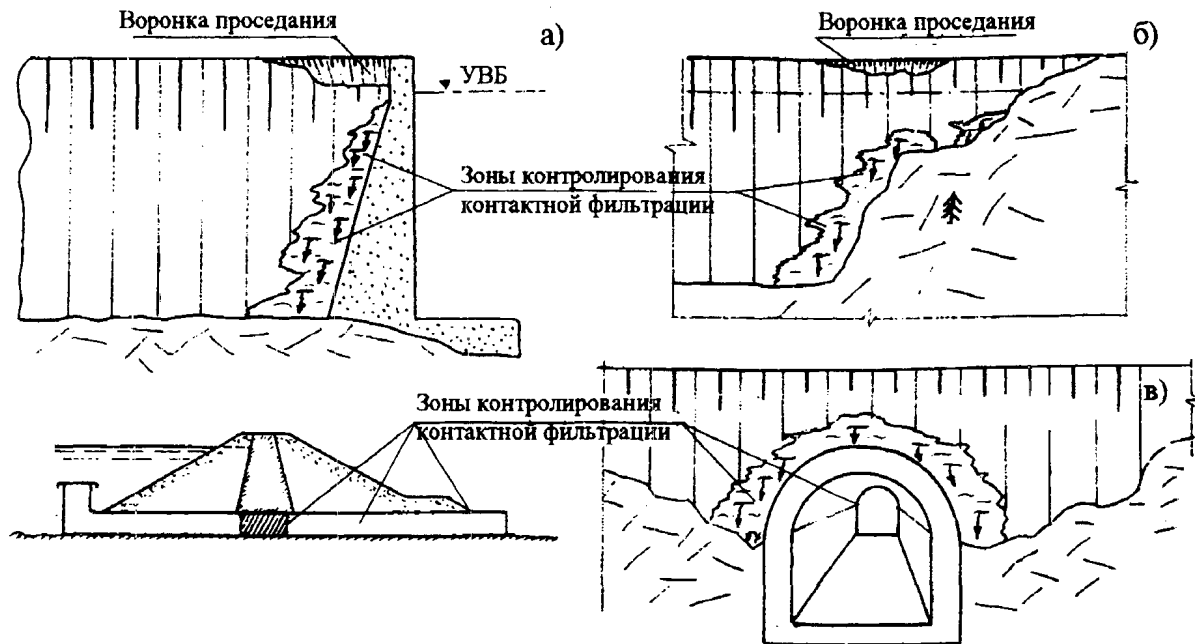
Зоны визуального контроля сопряжения плотины с берегами и бетонными сооружениями
